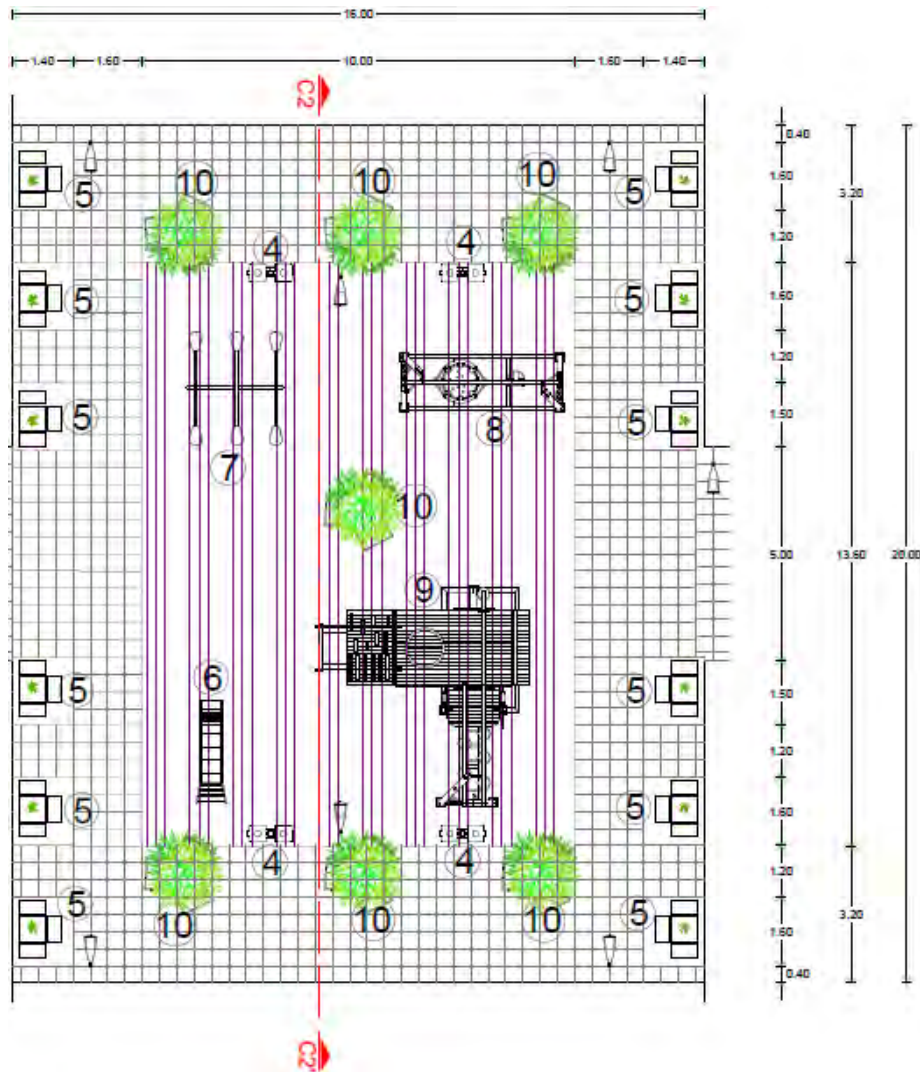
Planta arquitectónica de la plaza 1. Se observa la distribución del mobiliario ocupado y el cambio de piso.
